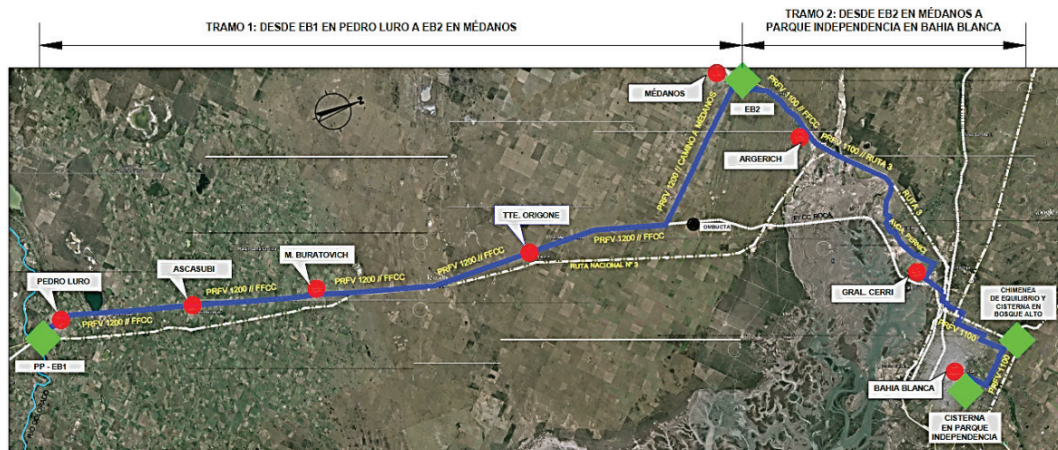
c. Planimetría general de las obras principales (Localidades en rojo y Cisternas en verde)
